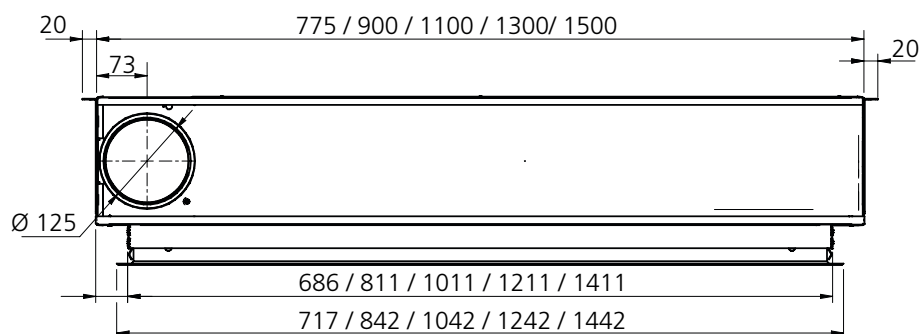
Dimensions externes: Vue arrière, côté gauche -L
